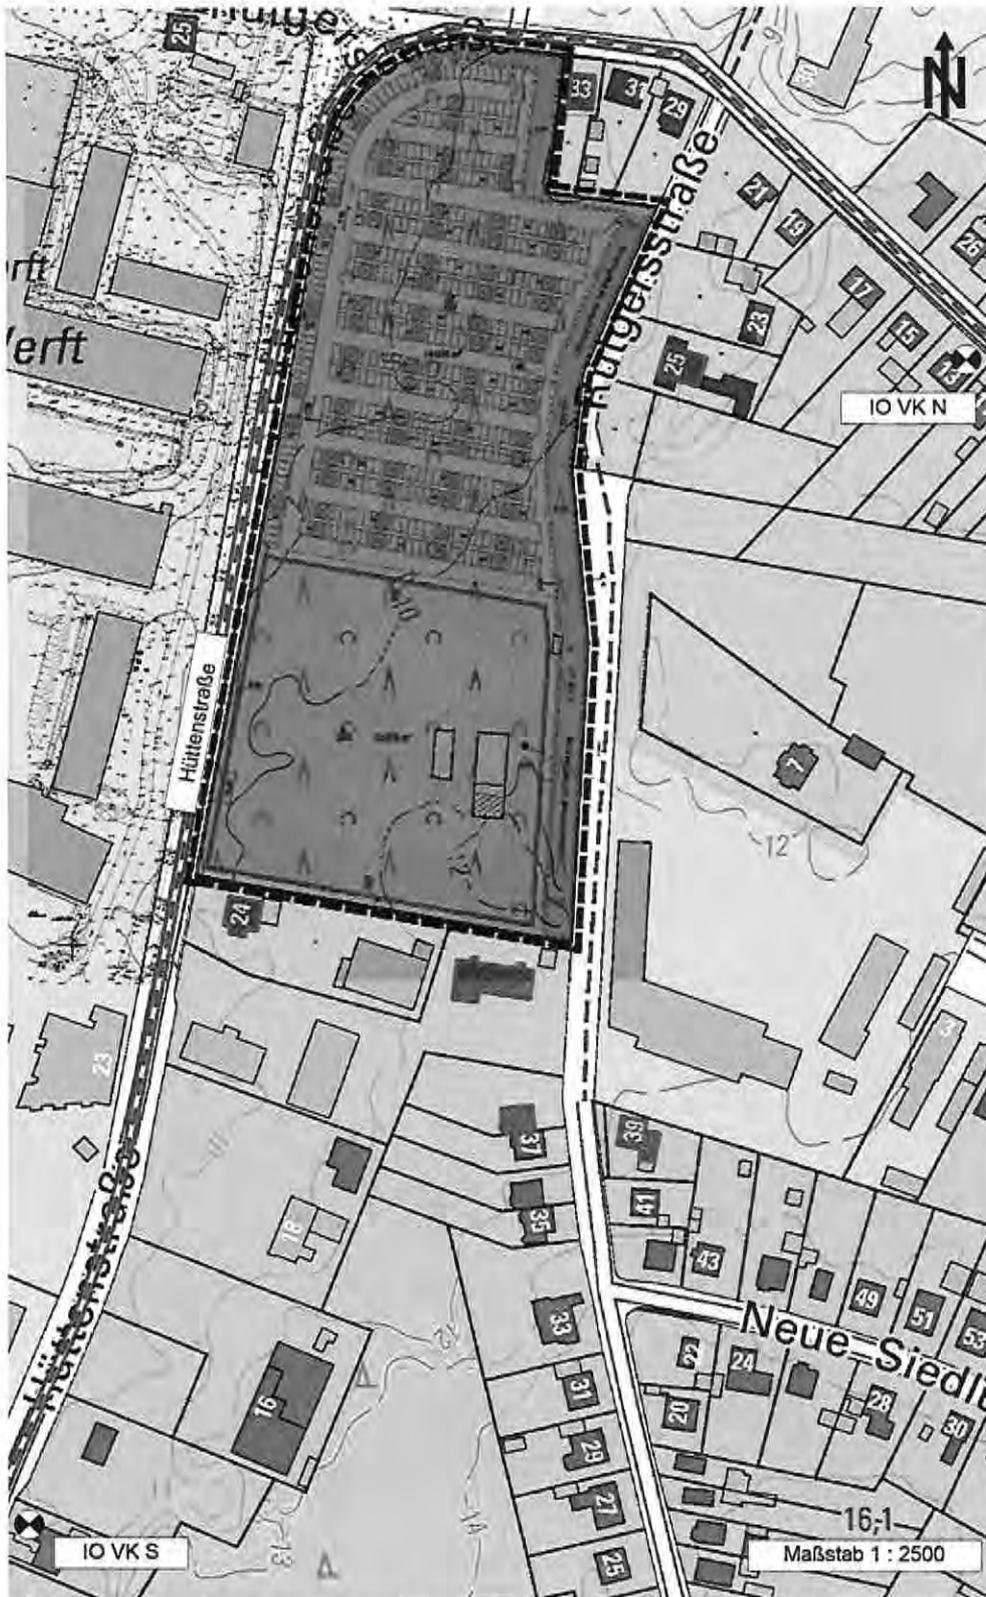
Lageplan Plangebiet mit Emissionsmodell Verkehrsgeräusche und Immissionsorten.
